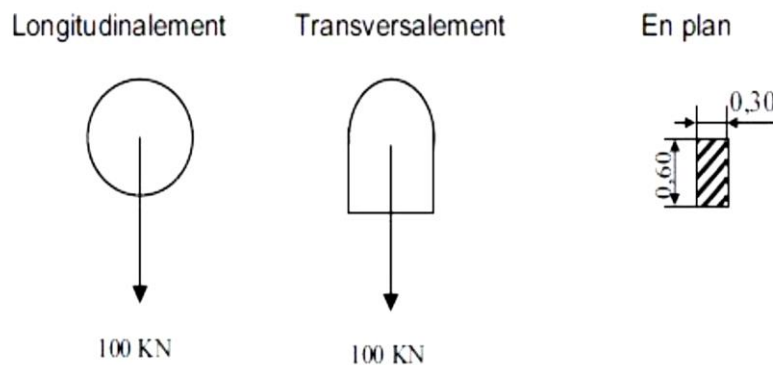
Disposition du sous-système B_r (D.T.R-RCPR 2008)
